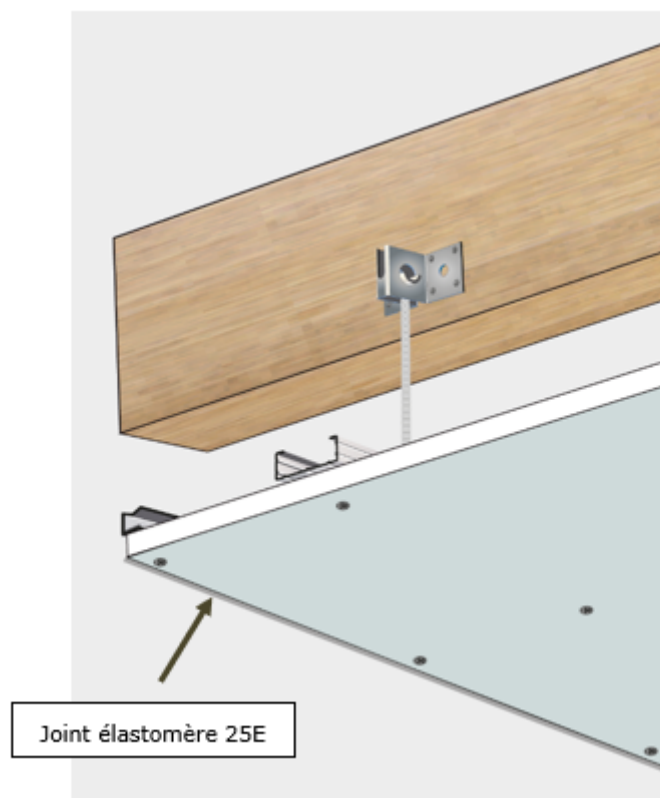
Dispositif de suspension sous charpente bois-Détail raccordement plafond - mur avec joint élastomère
